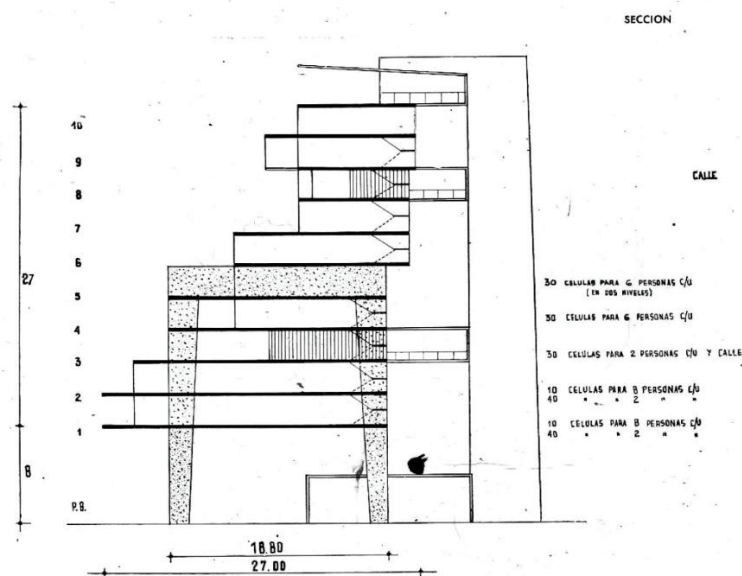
EPBA, Bajo Belgrano. Prototipo de bloque escalonado (1948). *Revista de Arquitectura* número 369, enero-febrero 1953.
